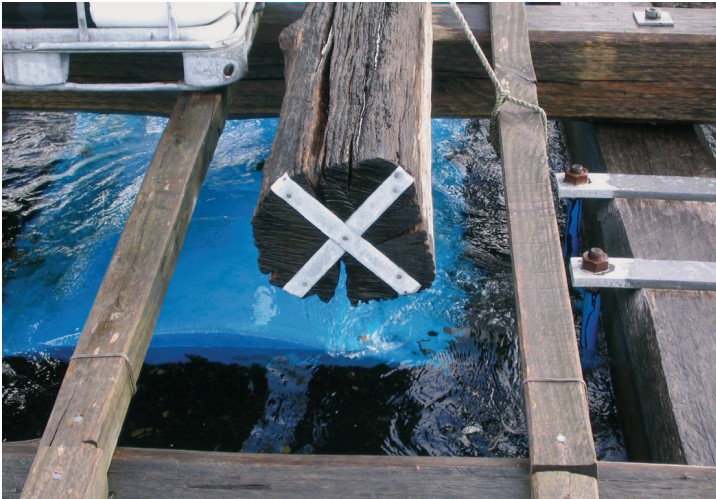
Grieta reparada en vigas de amarre (GA).
